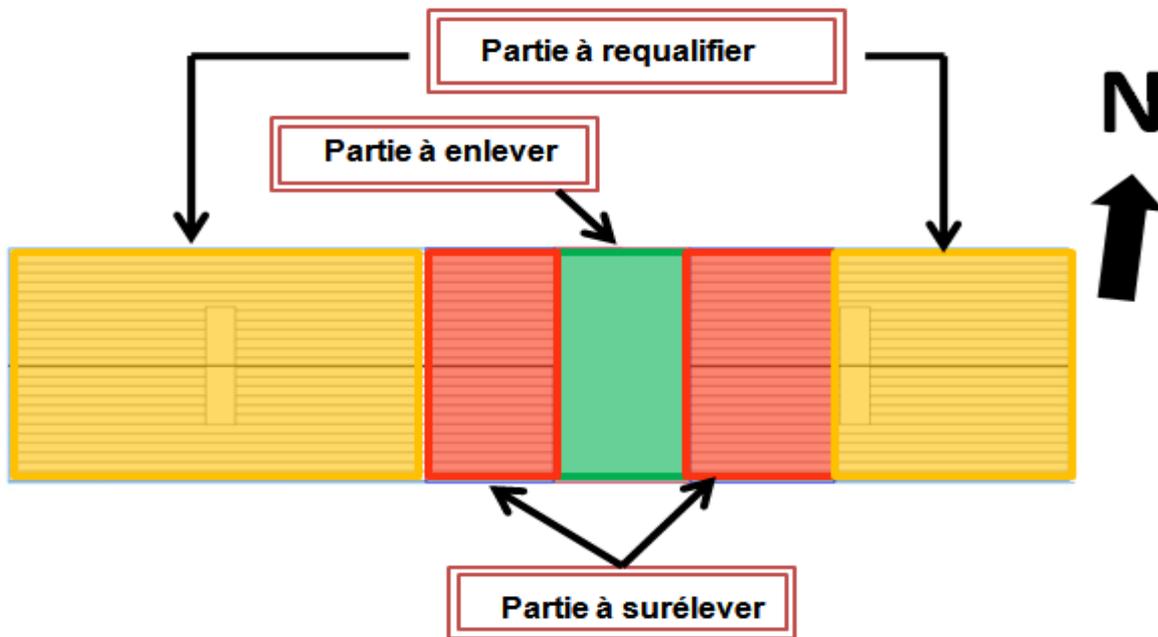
Schéma d'intervention sur la toiture du bâtiment existant
